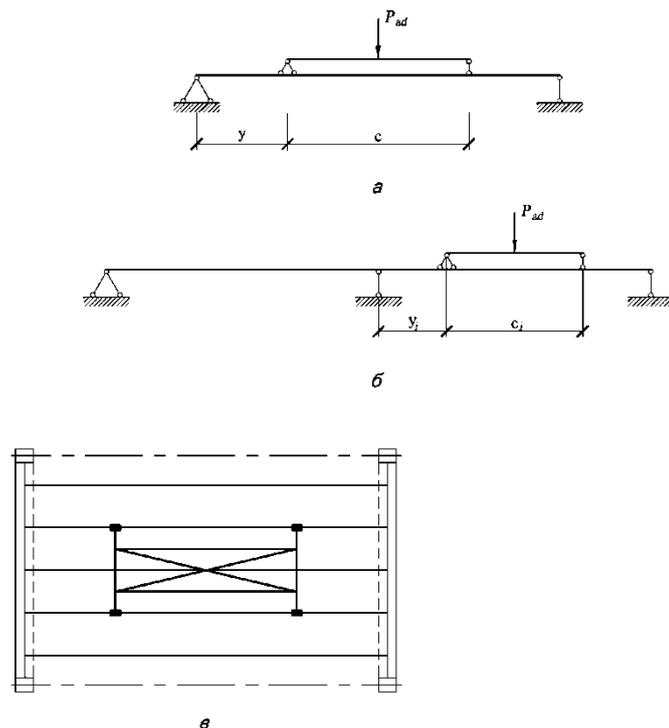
Принципиальные схемы распределительных устройств при усилении: а – однопролетной балки; б – неразрезной балки; в – сборных плит перекрытия
